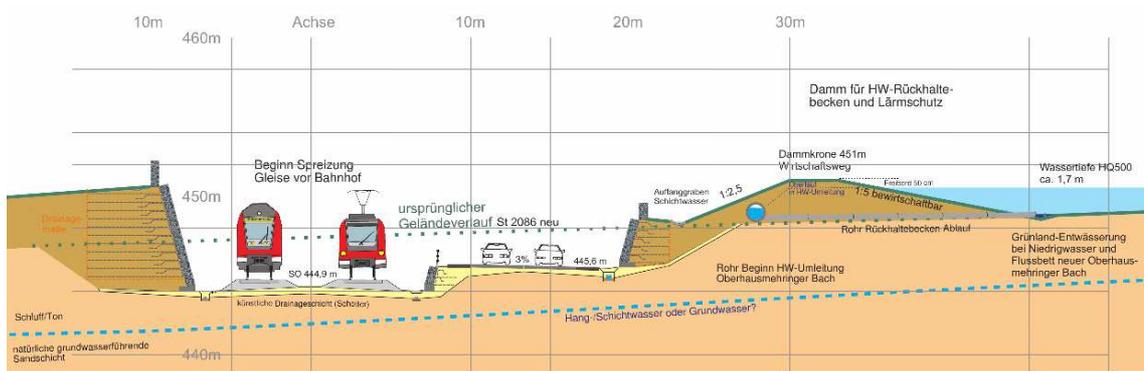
Einschnitt mit Eisenbahn, Staatsstraße, Entwässerung; rechts davon Lärmschutzdamm und Hochwasser-Rückhaltebecken
